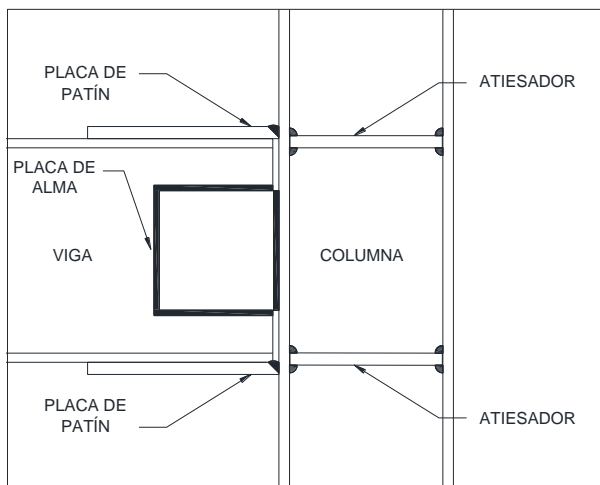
Esquema de conexión viga-columna a través de placas soldadas.
